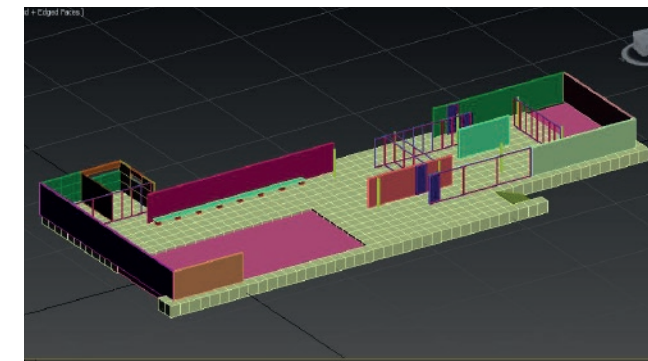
Modelado tridimensional del Pabellón de Barcelona sin cubierta
